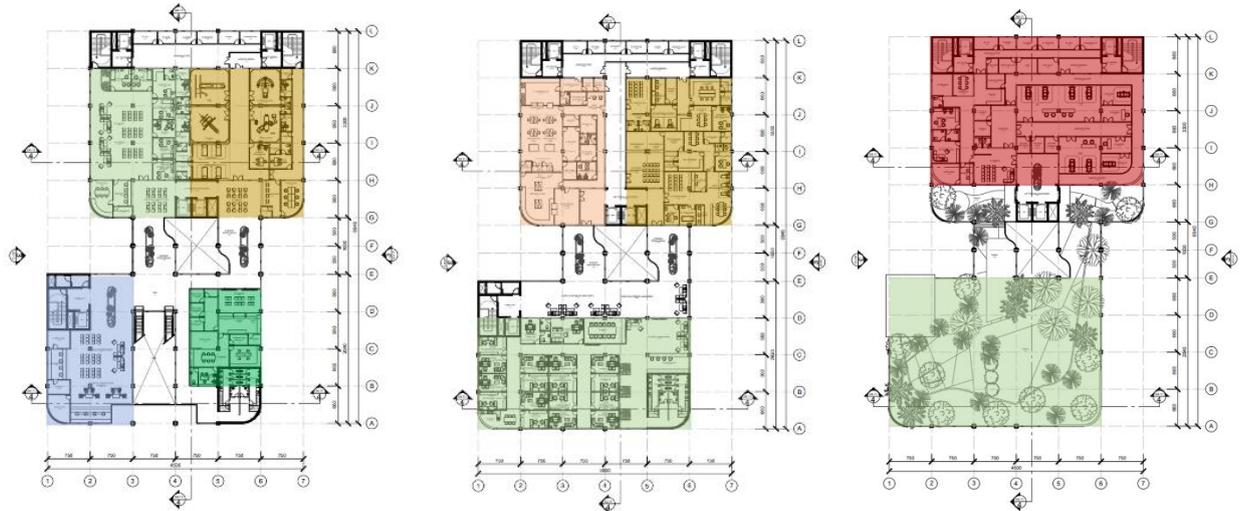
Zona Dalam Bangunan Lantai Basement 2, Basement 1 dan Lantai Dasar
